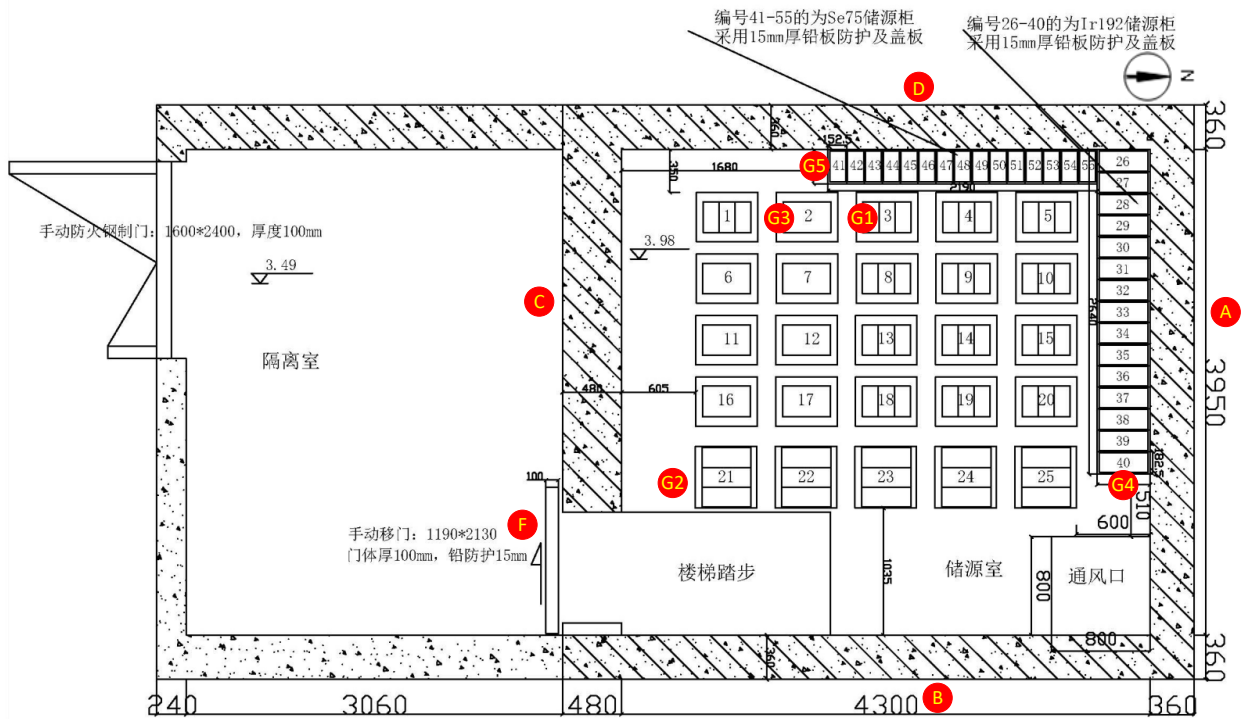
放射源库平面布局（扩建后）及辐射预测点位示意图（单位：mm）
